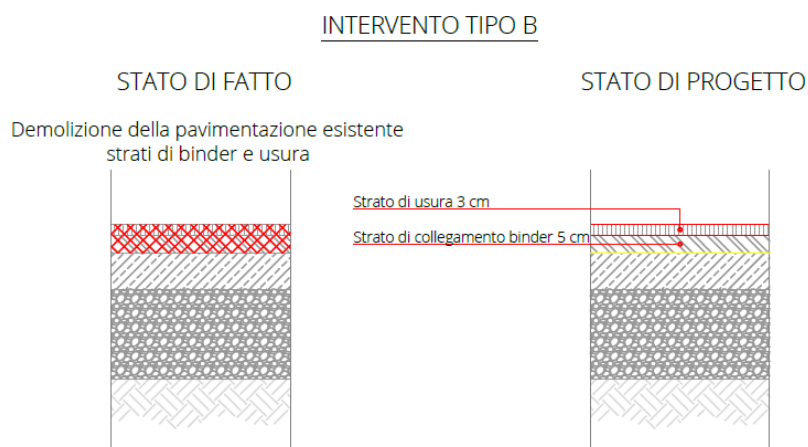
Rifacimento pavimentazione stradale – Tipo B
